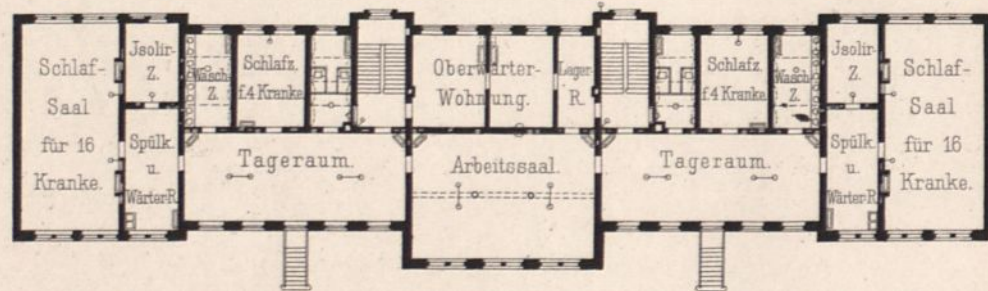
Krankenhaus A. Grundriß des Erdgeschosses.
